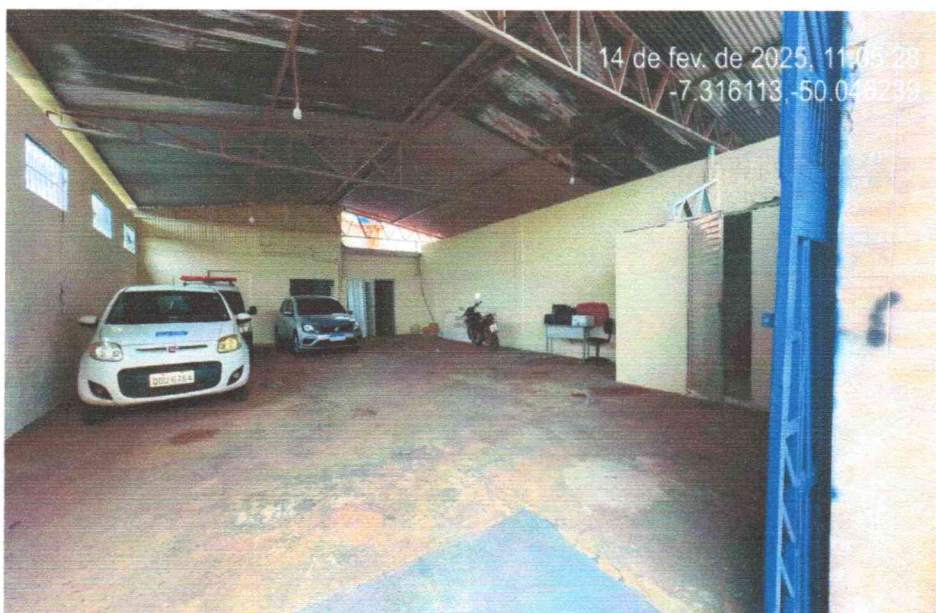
Avenida 12: Acesso Principal 4 para Garagem
